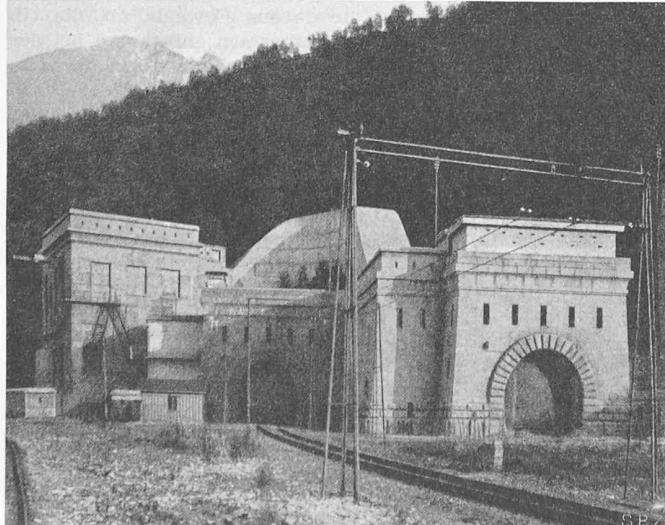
Nordportal des Simplontunnels bei Brig, mit Lüftungsanlagen (links) und (geschlossenen) Portal-Vorhängen. 1915
